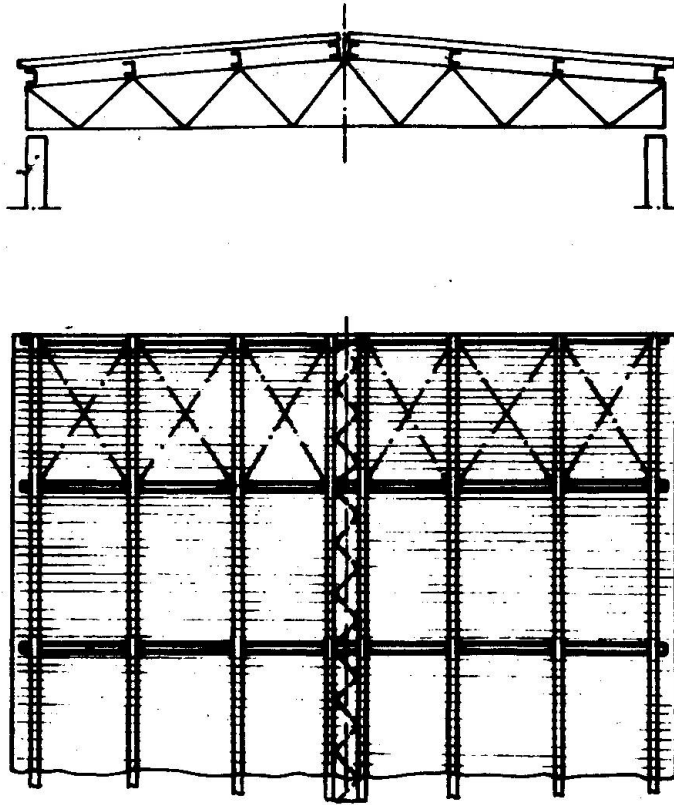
Übliche Dachkonstruktion, die profilierten Bleche verlaufen vom First zur Traufe.
